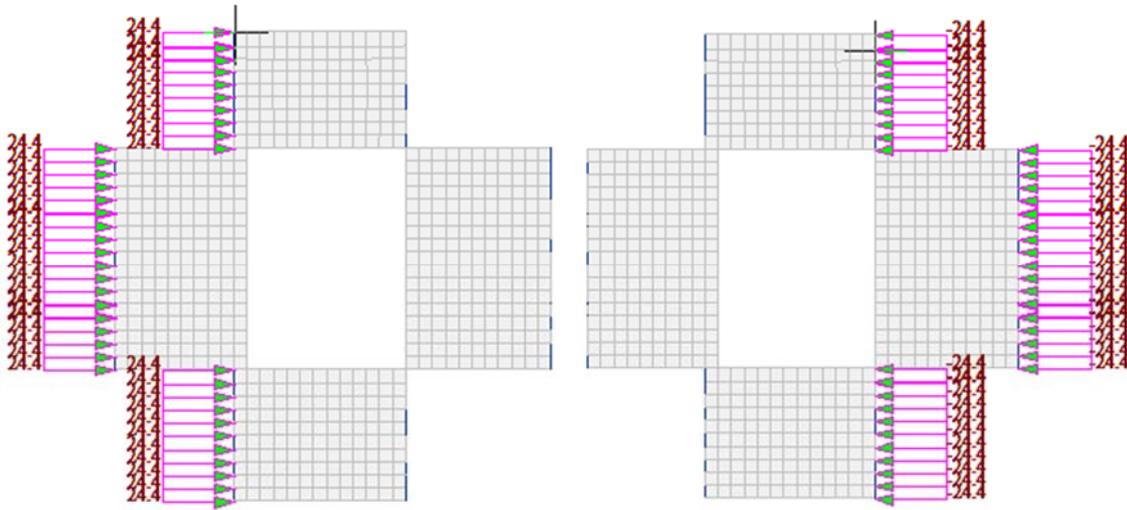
Incrementi di spinta in condizione sismica del terreno in direzione Y (pareti X) – Ey+ e Ey-
